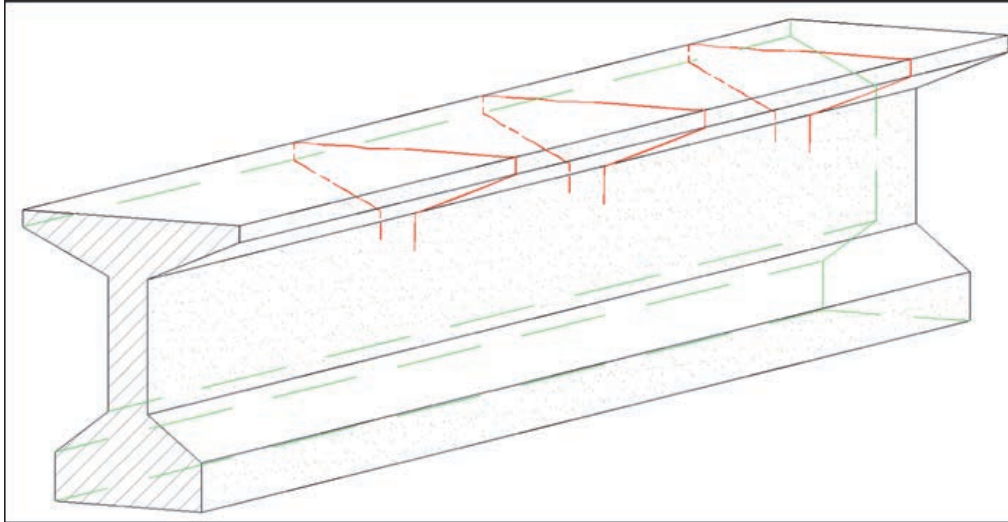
FISURAS EN CABEZA SUPERIOR DE VIGA DOBLE T.
